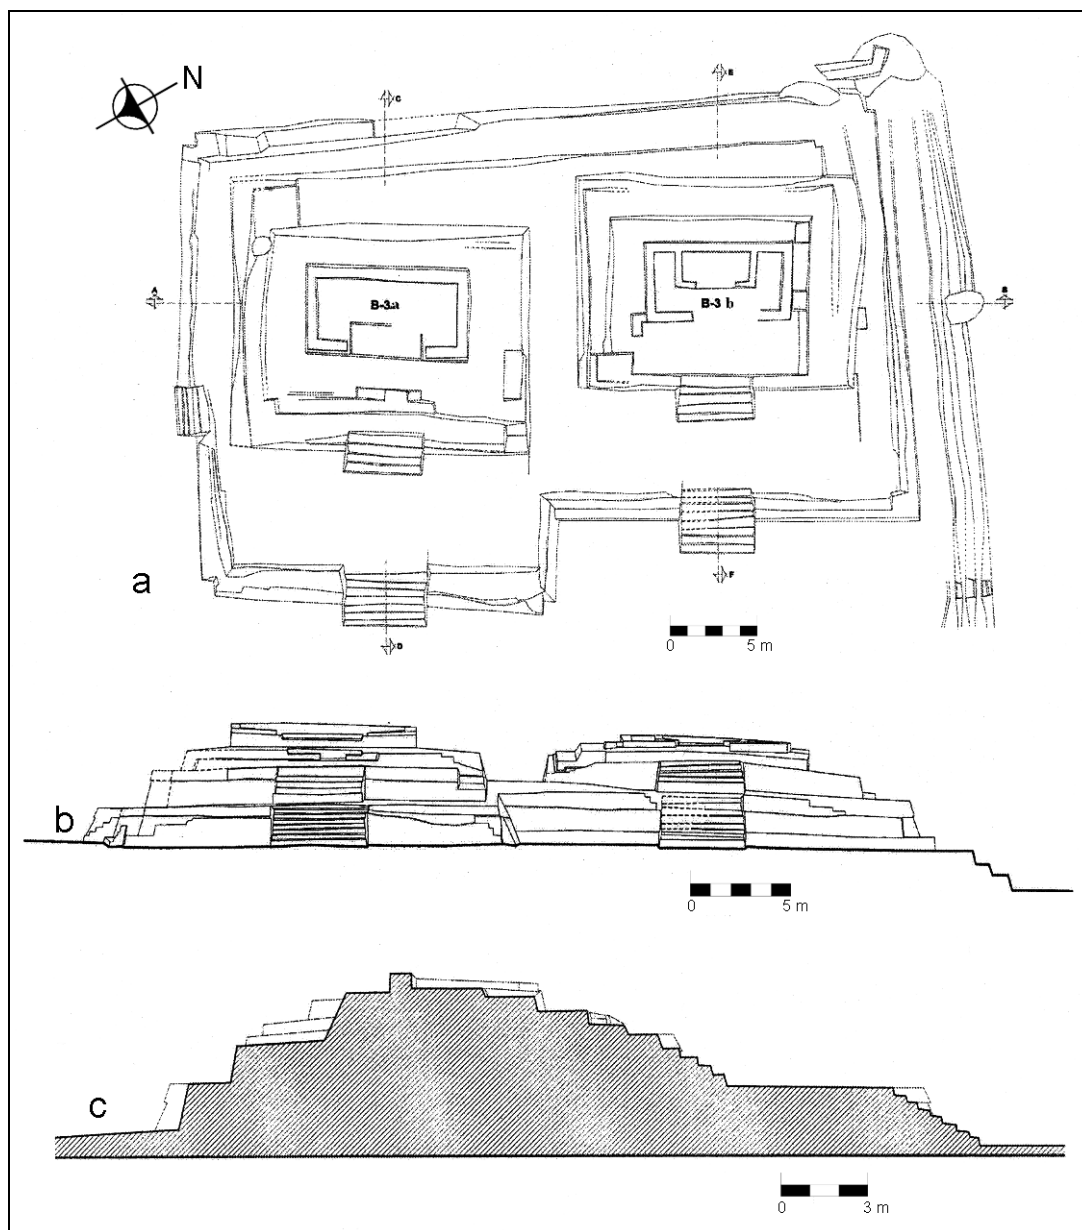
Estructura B-3, Grupo B. a: Planta; b: Fachada Principal; c: Corte C-D. Proyecto Arqueológico Isla Vieja, Tonalá, Chiapas. CONACULTA, INAH (Levantamiento O. Reyes).
